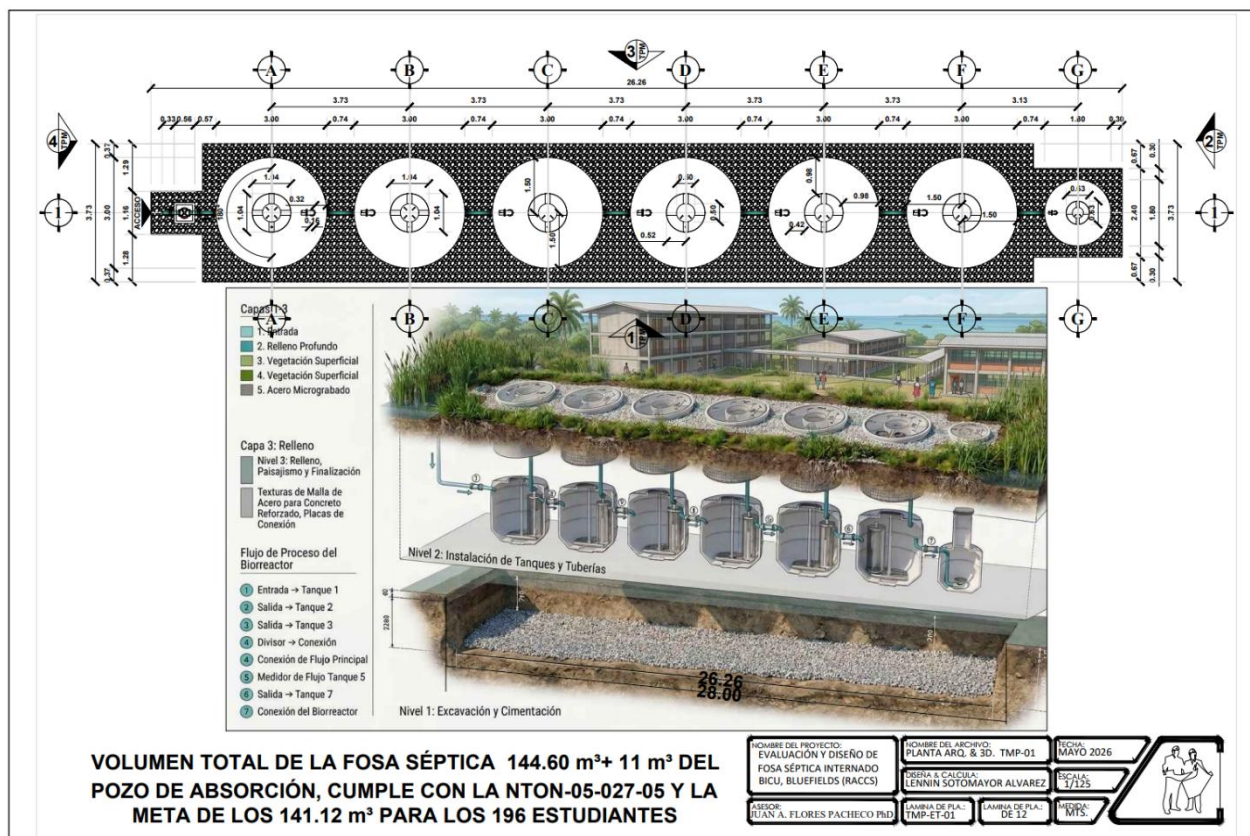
Planta arquitectónica y visualización 3D de la alternativa modular con tanques prefabricados para el sistema séptico del internado de BICU, Bluefields.
